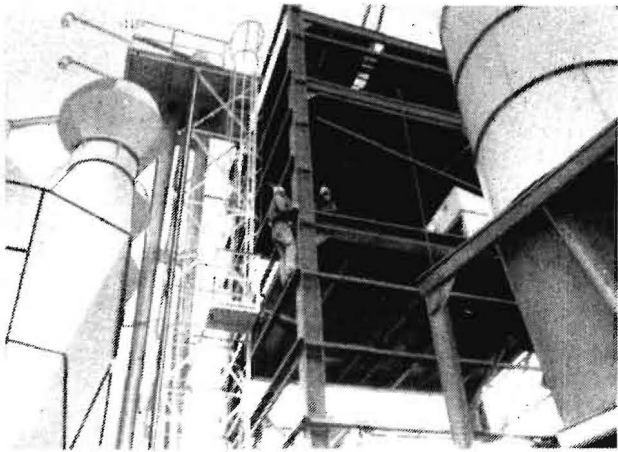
Fast alle LTA-Betriebe sind als Schweißbetriebe und Montagebetriebe für den Stahlbau zugelassen, im Bild ist die Montage eines Maschinenhauses für eine Getreidesiloanlage zu sehen
